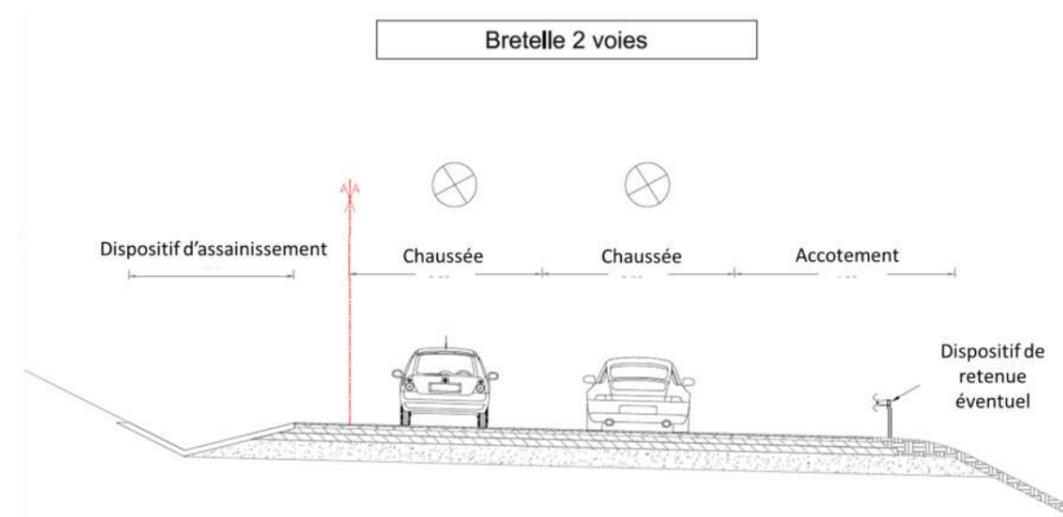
Profil en travers type mis en œuvre sur la bretelle de sortie n°1 à deux voies.
